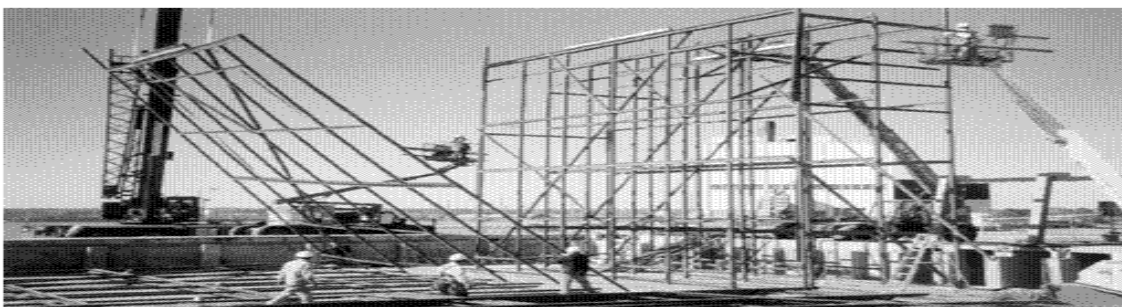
Poutres et colonnes en FRP utilisés pour la construction d'un bâtiment.
